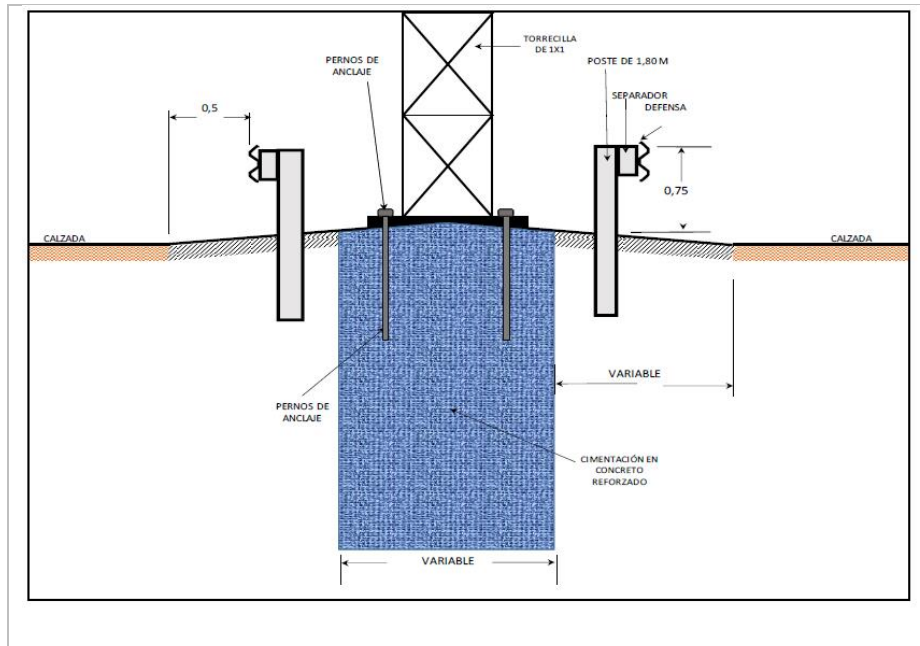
Vista transversal de las defensas metálicas en tramo de postes en concreto (tramo típico).
